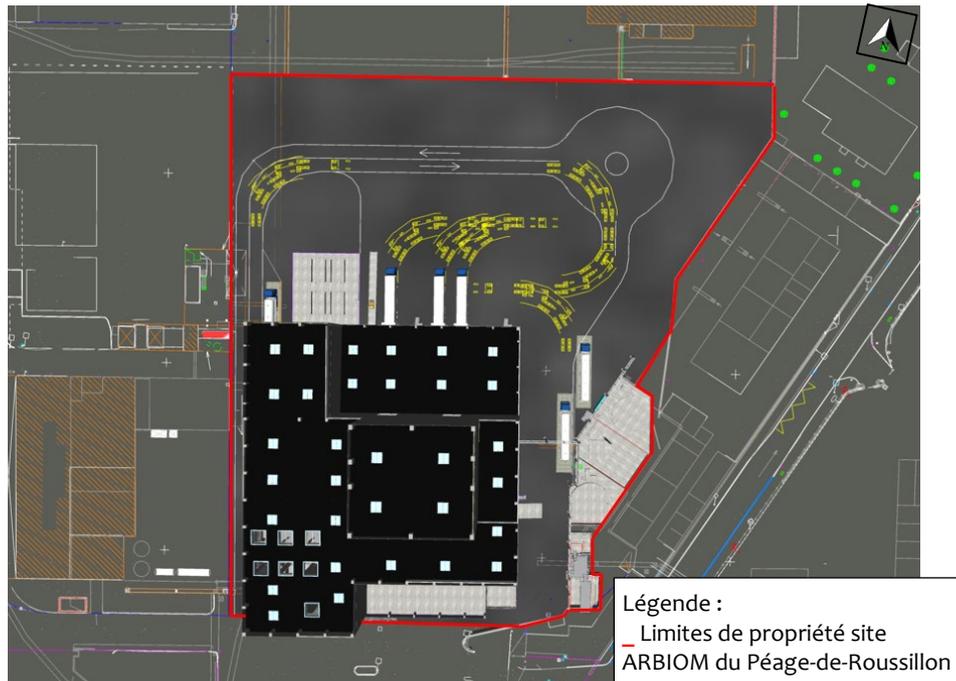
Plan général du site ARBIOM du Péage-de-Roussillon - Echelle 1 / 650
